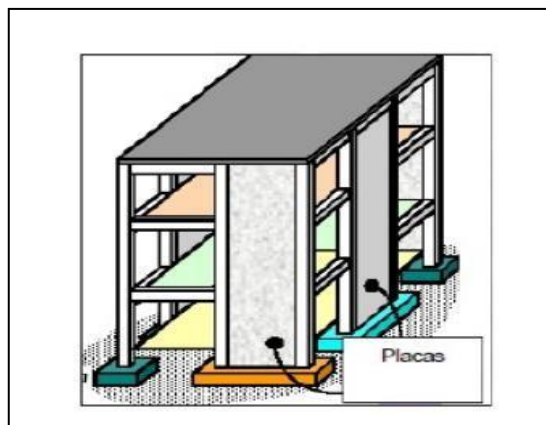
Sistemas estructurales duales de pórticos y placas de concreto armado.
